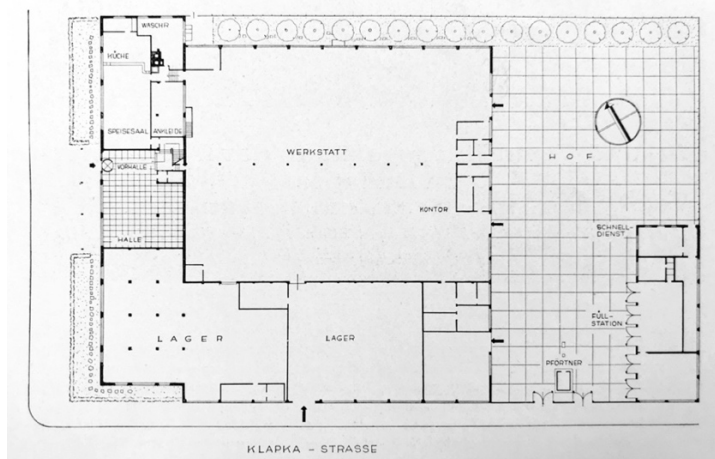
Edmund Körner/P.F. Schneider, Ford-Motor-Ges., Budapest, Grundriss Erdgeschoss
